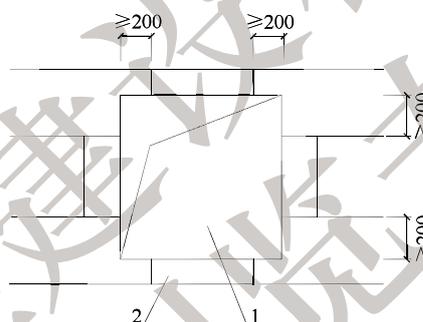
门窗洞口保温板排板示意（尺寸单位：mm）
